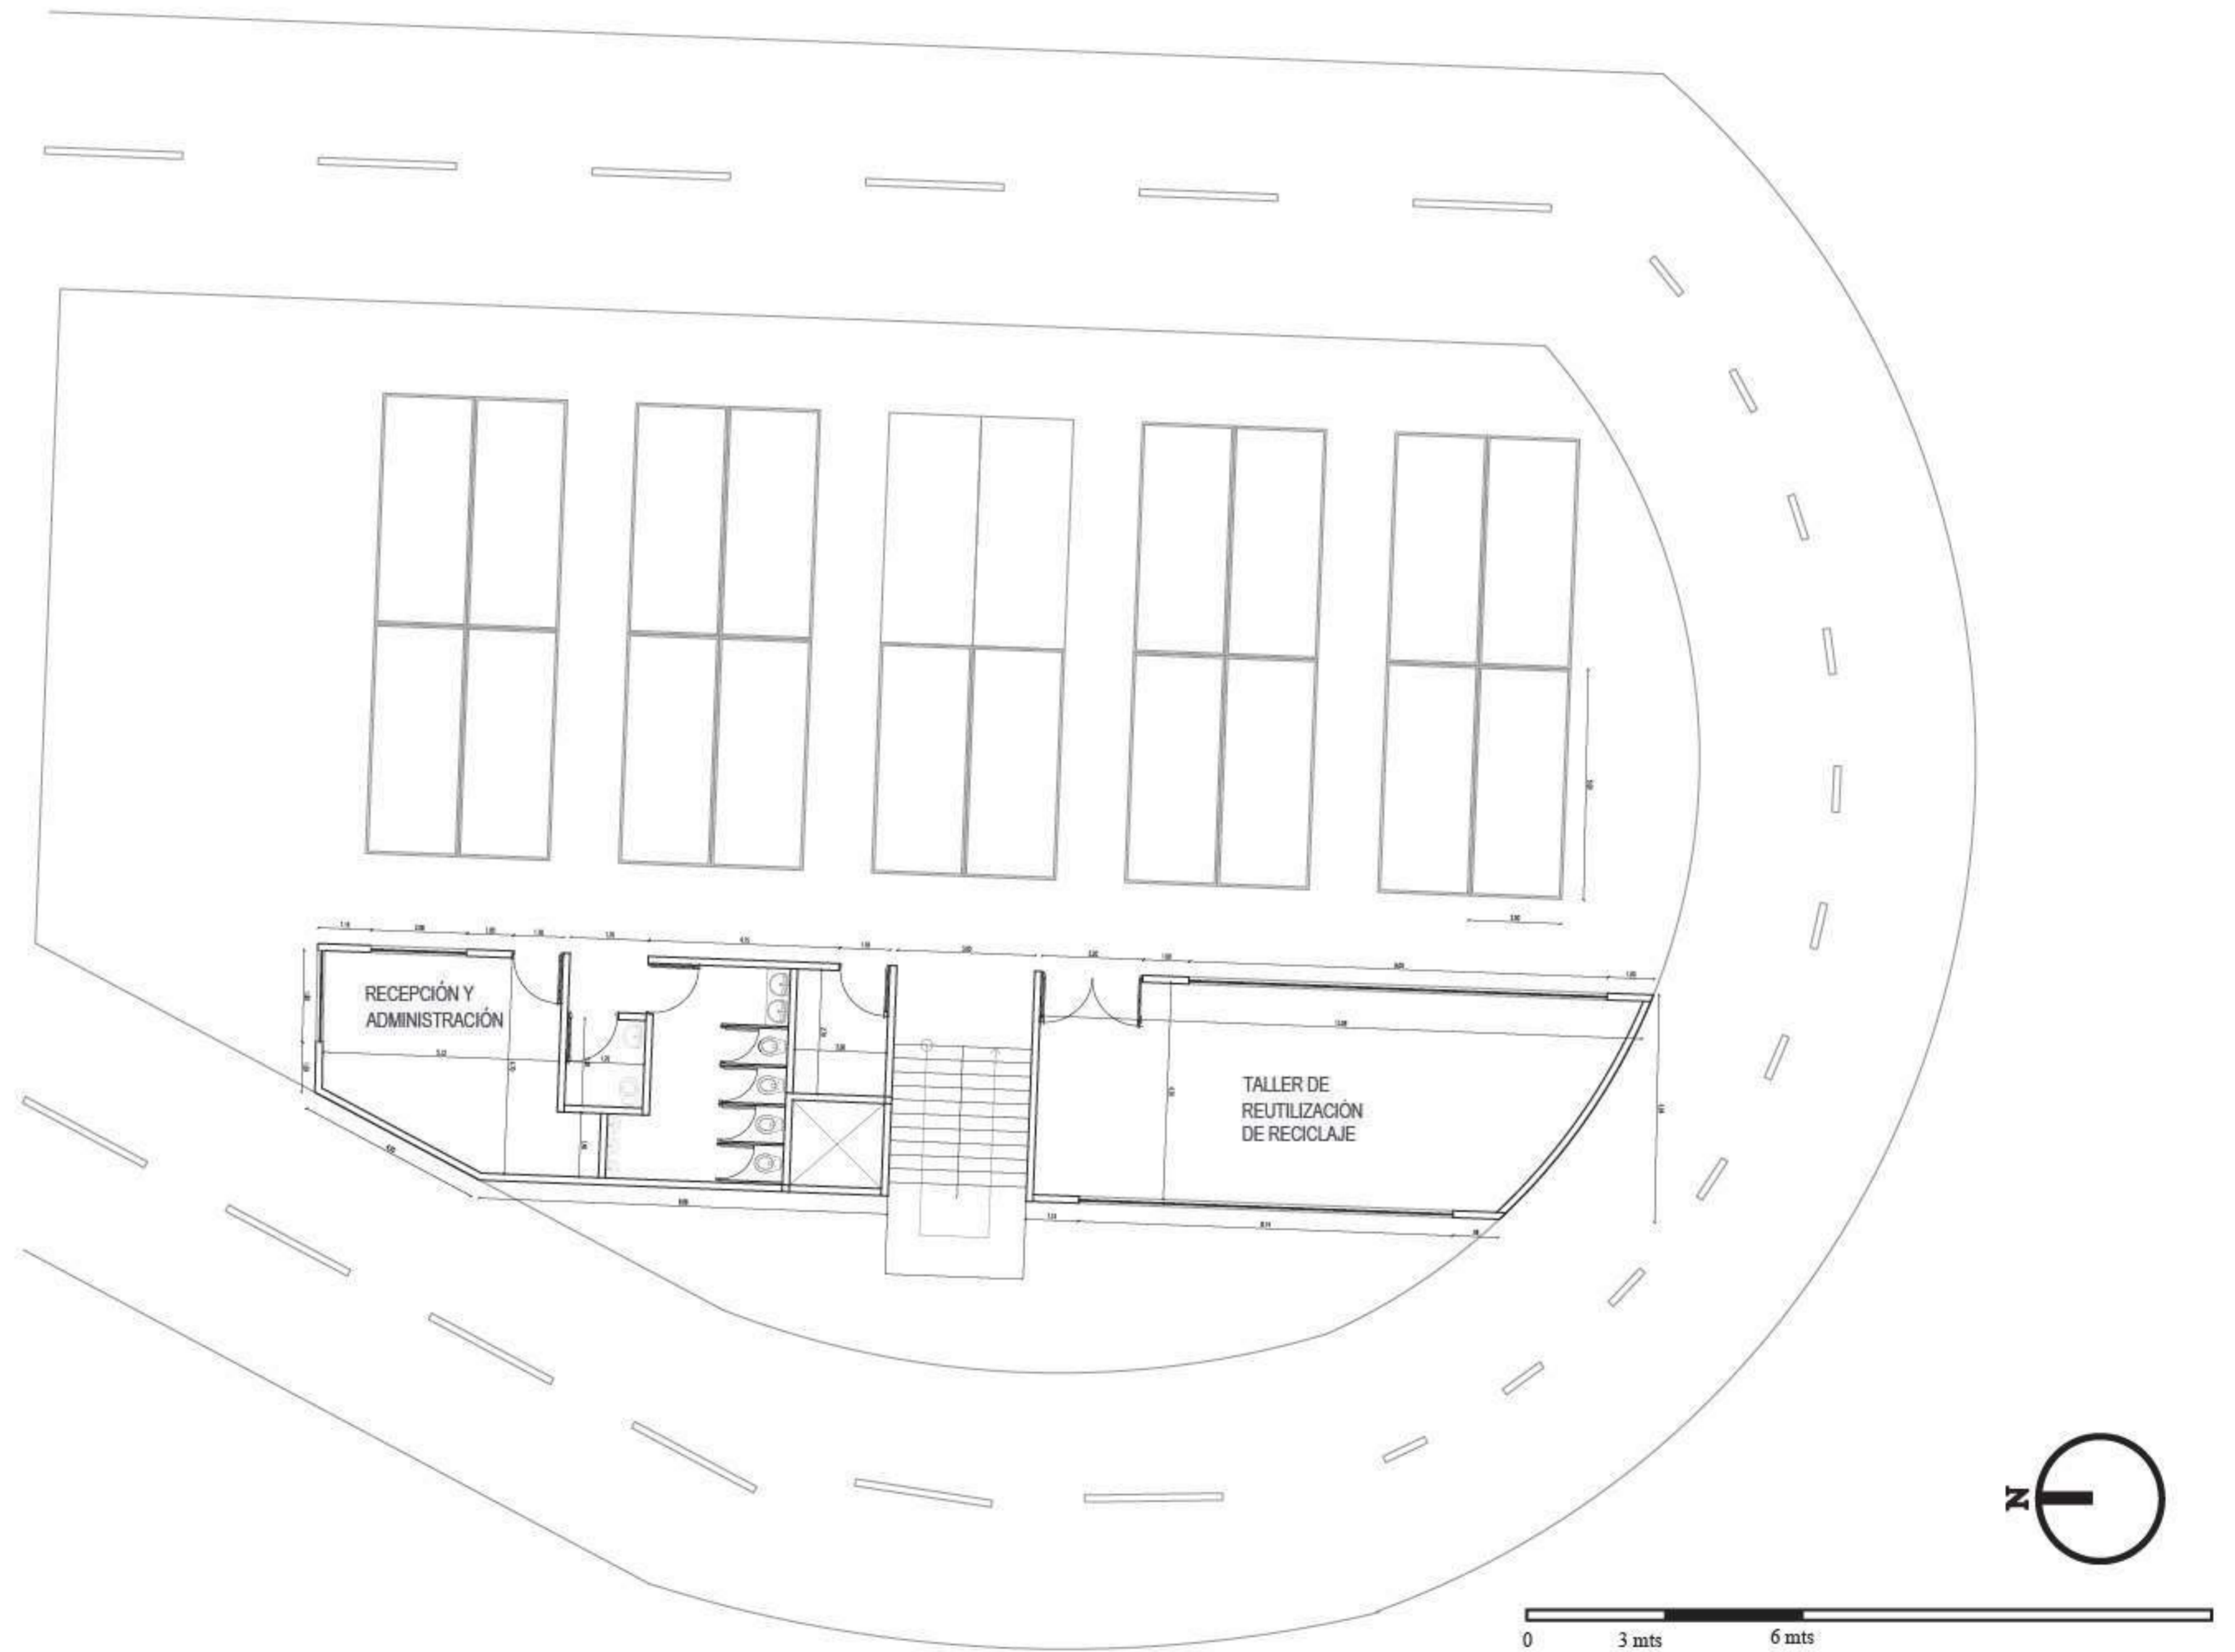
, planta centro de reciclaje, Elaboración propia (2021)
